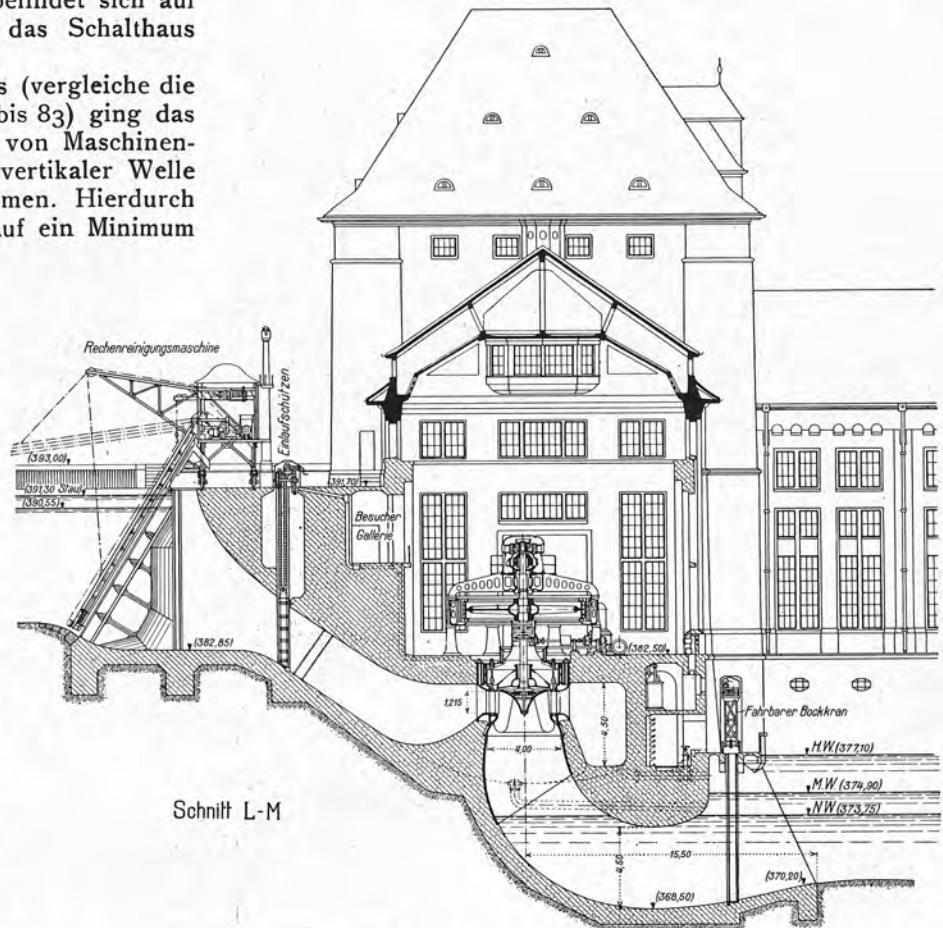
Maschinenhaus des Kraftwerks Gösgen. — Querschnitt durch Einlauf und Turbine. — 1:400.
